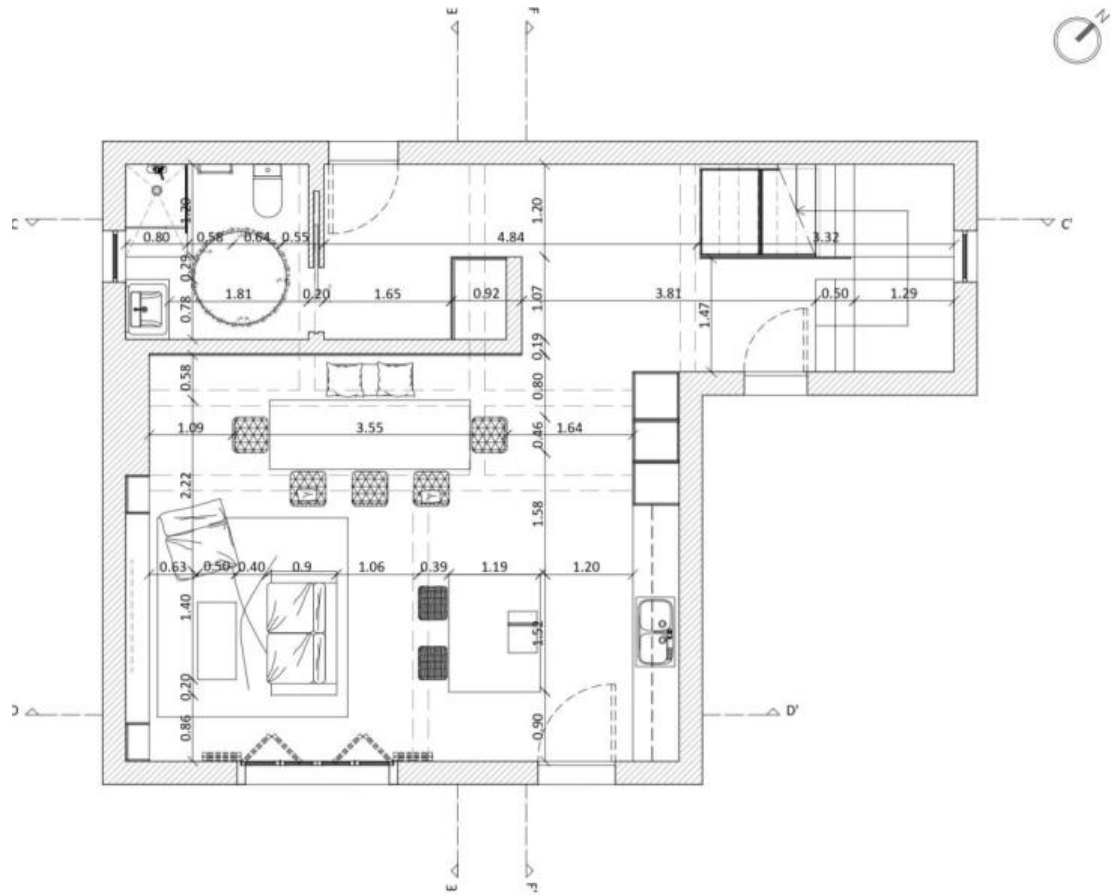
Planta de Equipamento e Mobiliário cotada, Piso 0. Fonte: Autor
